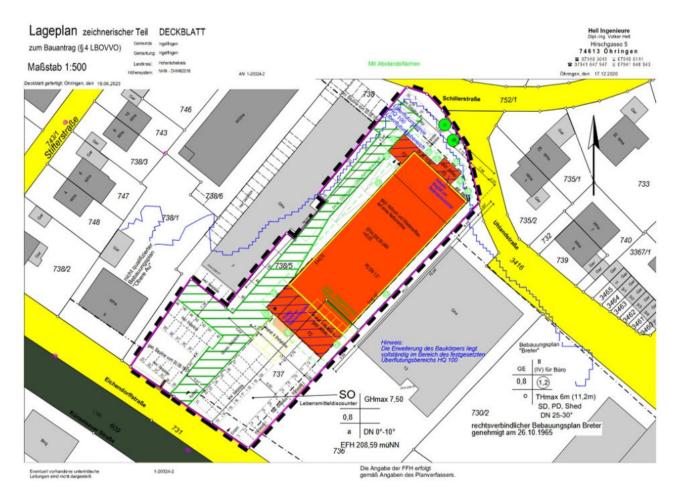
Übersicht Lageplan und Planbereich (Stand 19.06.2023)
